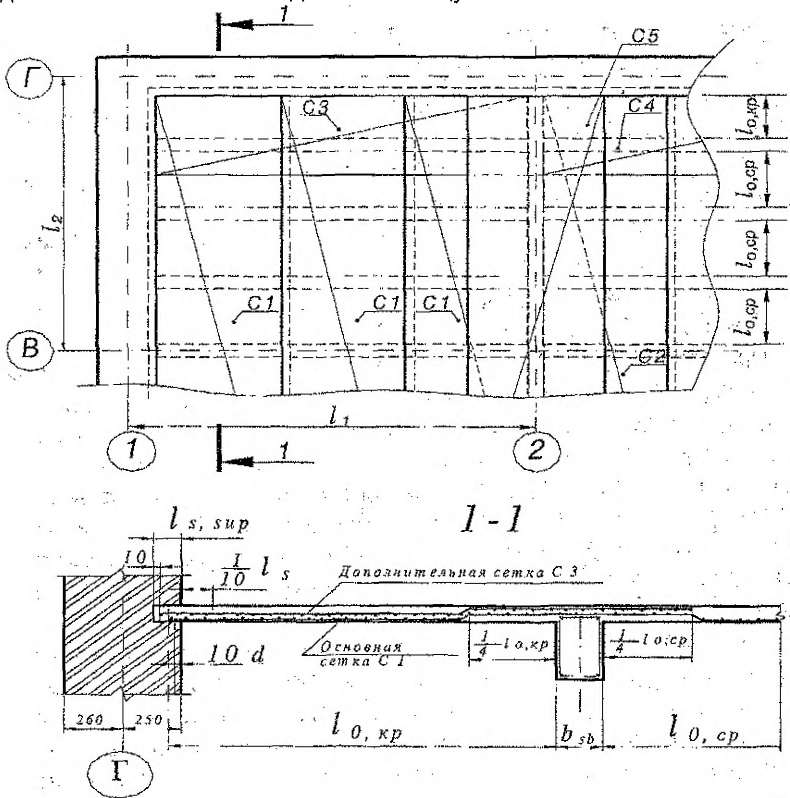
Непрерывное армирование монолитных неразрезных плит сварными рулонными сетками.
